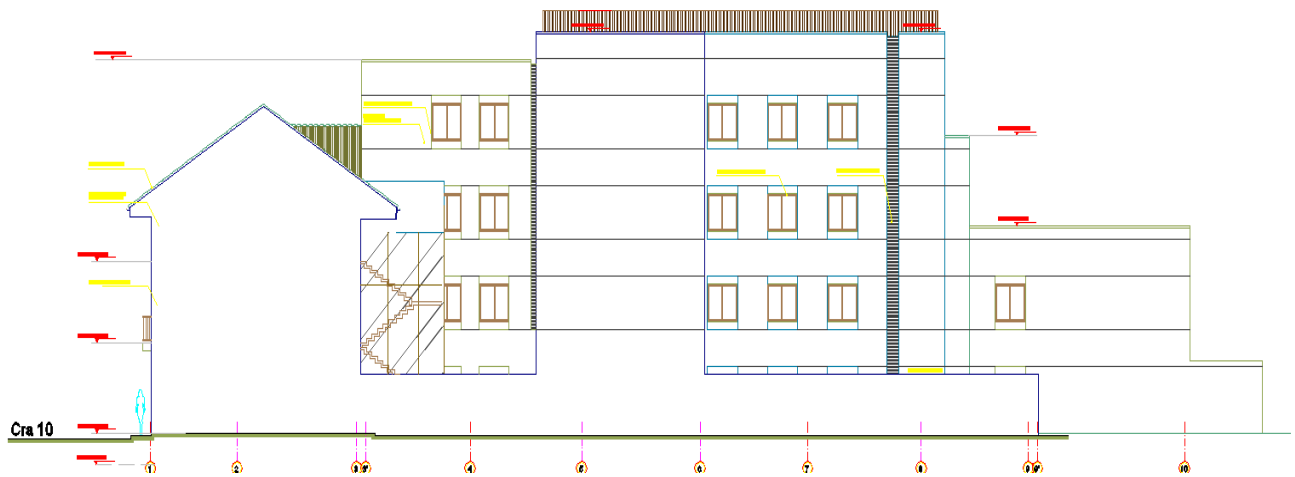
Fachada Urbana lateral derecha de la edificación (calle 4)
